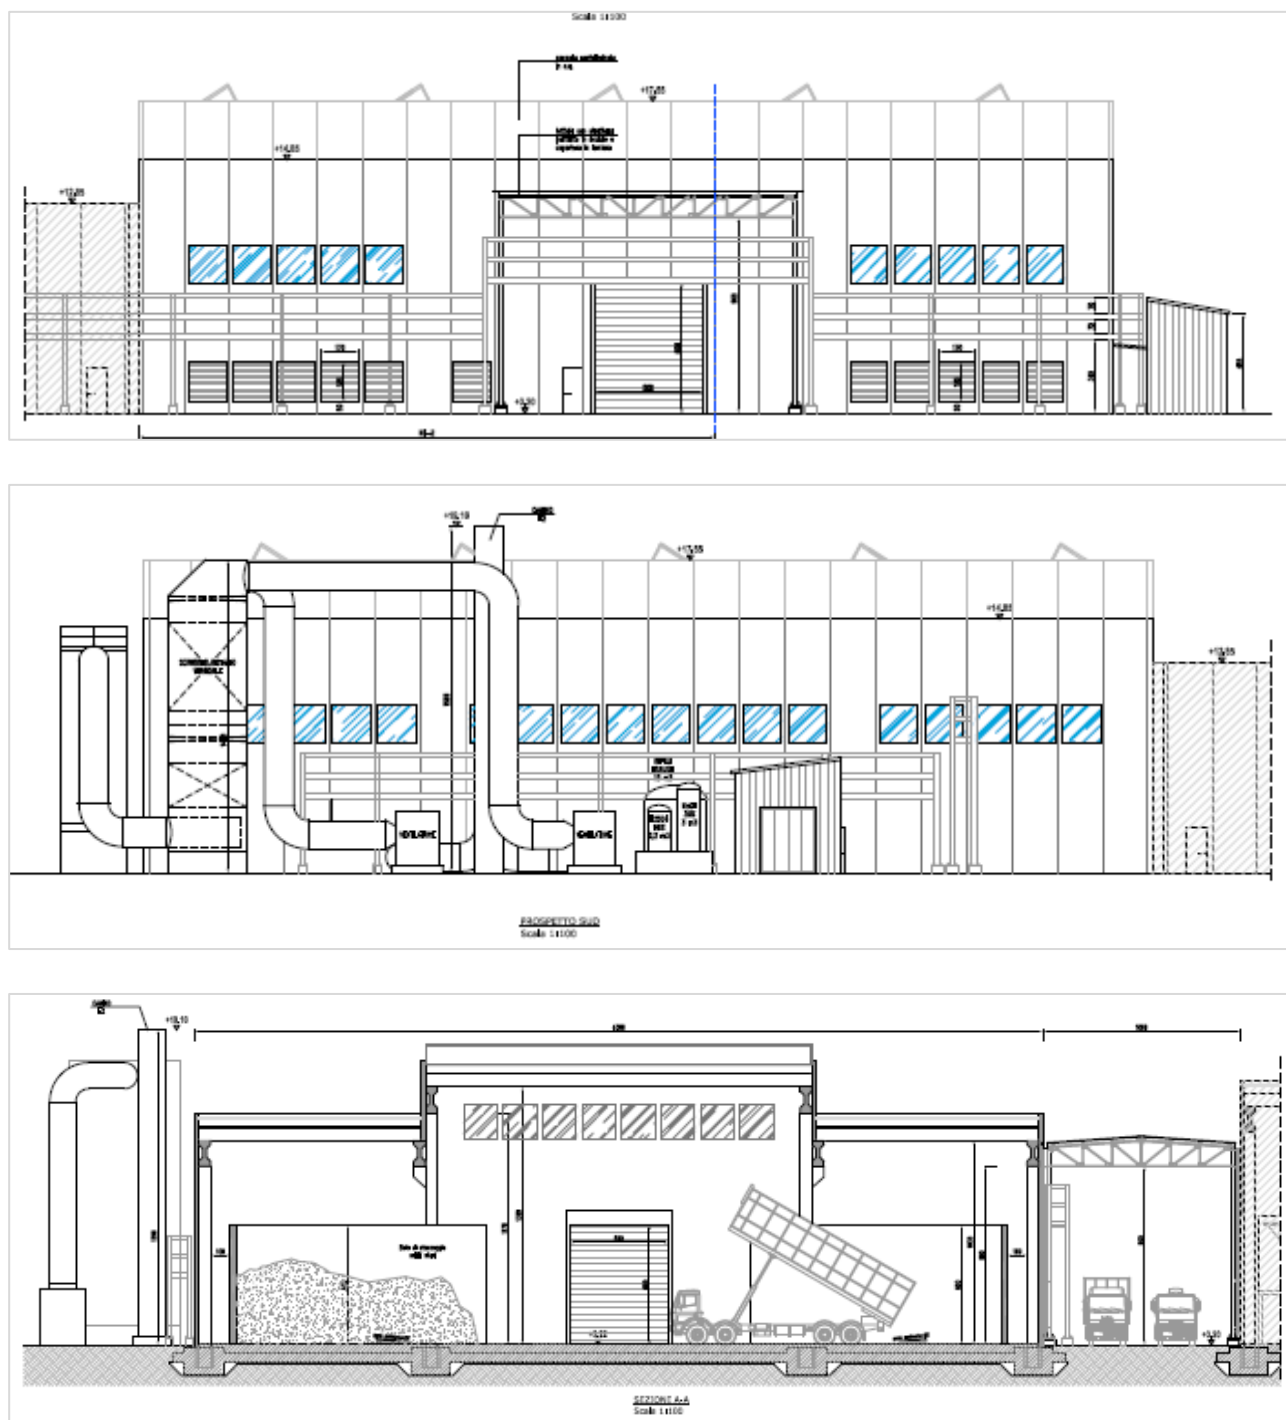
Prospetto A-A, NORD e SUD (Stralcio elaborato CO 05 RA VA 01 D1 PL 61.00 - N4 PROSPETTI E SEZIONII)
